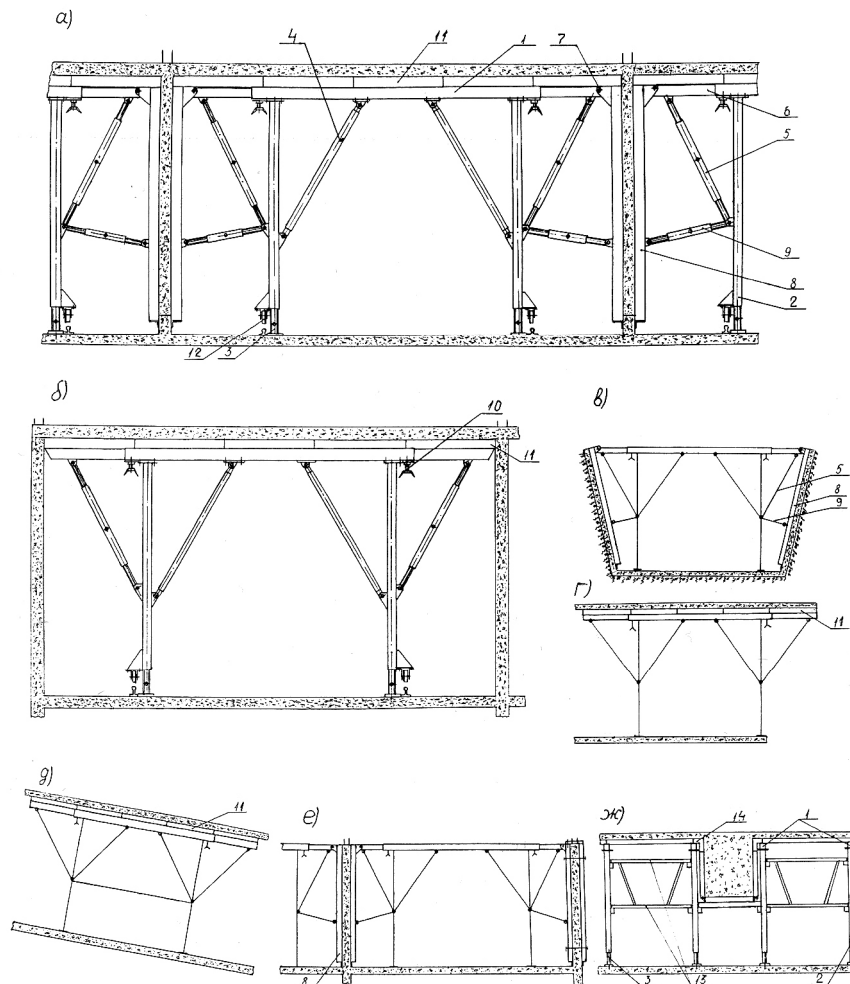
Область применения опалубки в монолитном строительстве. а) возведение стен и устройство перекрытий, б) устройство перекрытия, в) бетонирование боковых стен траншей, г) бетонирование консольных участков перекрытий и балконов, д) бетонирование наклонных участков перекрытий и лестничных маршей, е) возведение внутренних и наружных стен, ж) бетонирование железобетонных балок и перекрытий.
